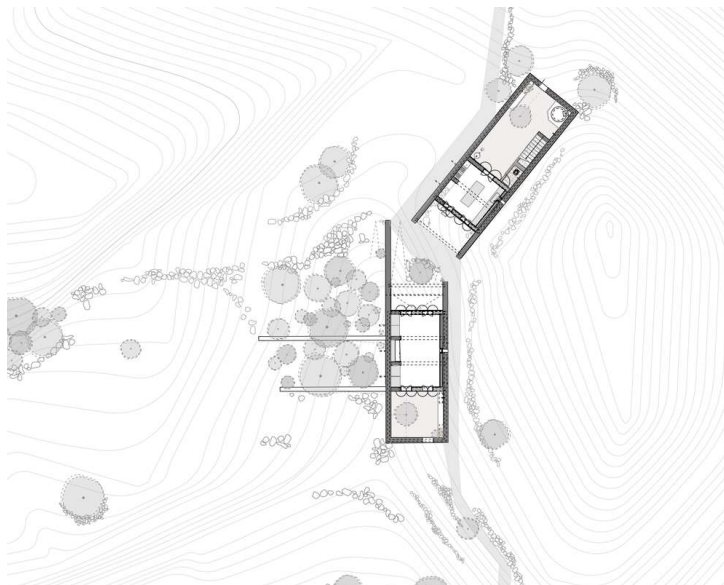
Plan du projet, tiré du site Archdaily.com.
